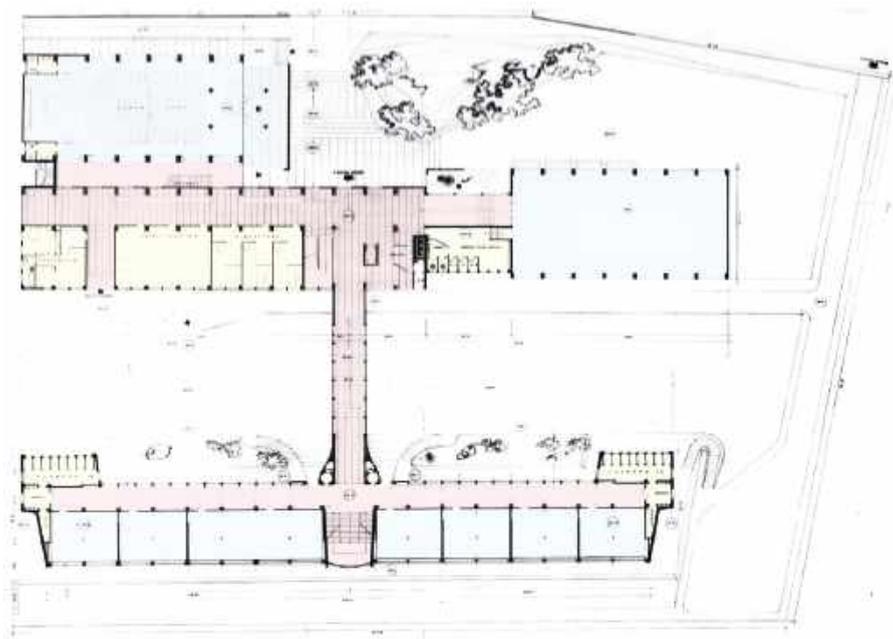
Pianta piano terra (rielaborazione, rosa-corridoi, giallo-servizi, blu-aule)
